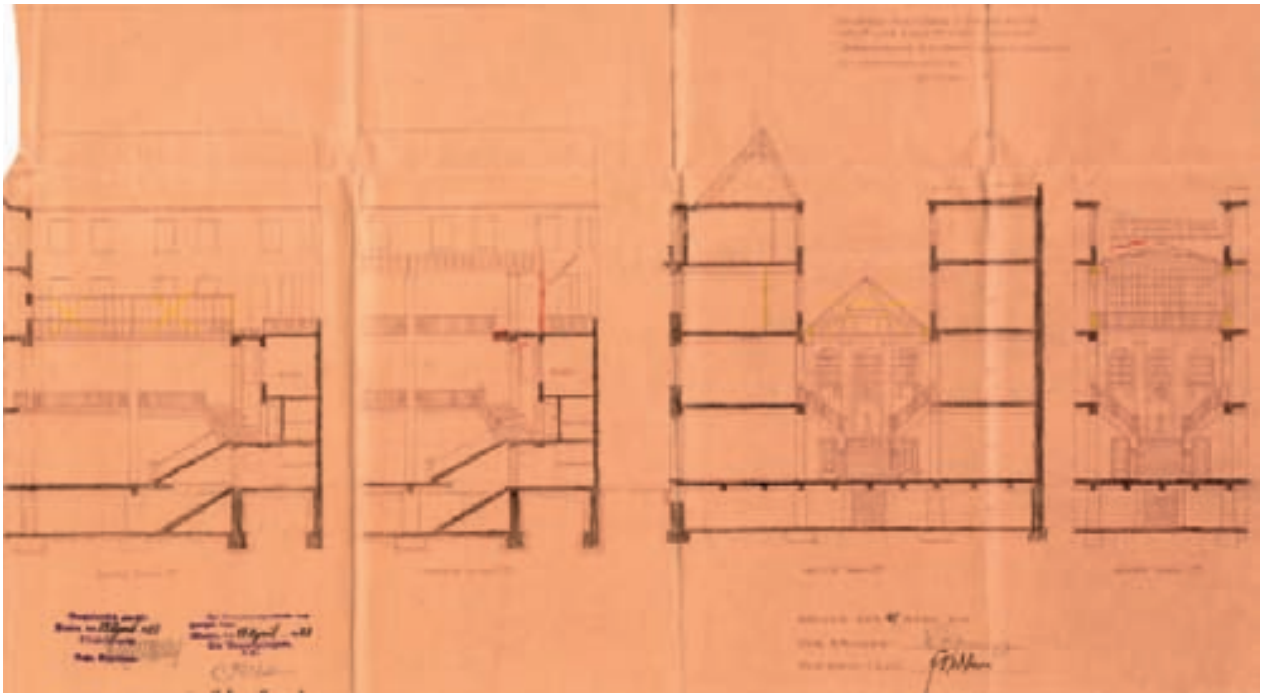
Menden, Hauptstraße 57, Umbauplan 1928, Gebäudeschnitte (Bauakten der Bauverwaltung, Stadt Menden)
